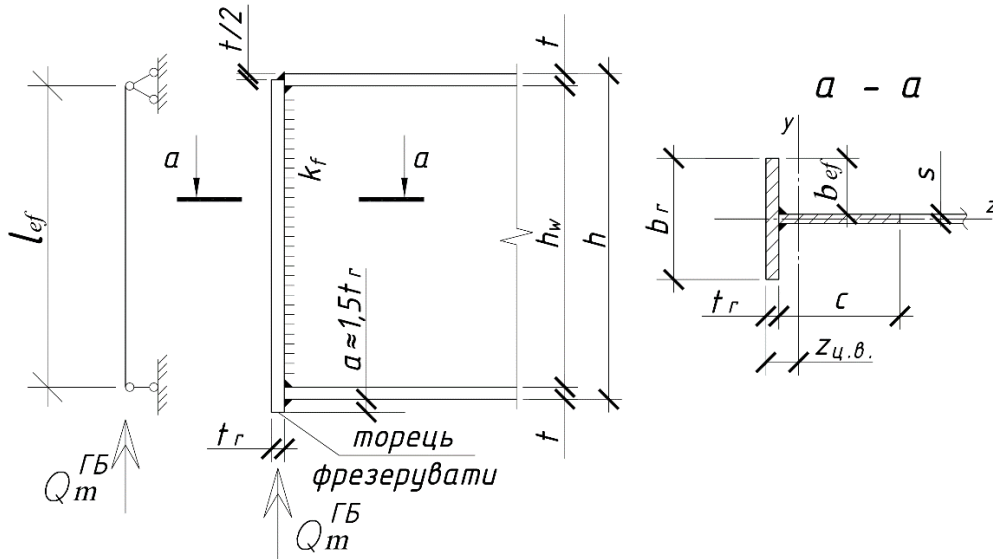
Конструкція та розрахункова схема торцевого опорного ребра головної балки
